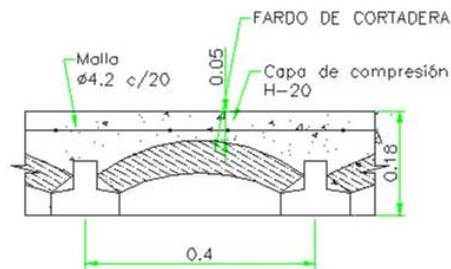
LOSA DE VIGUETAS CON FARDOS
